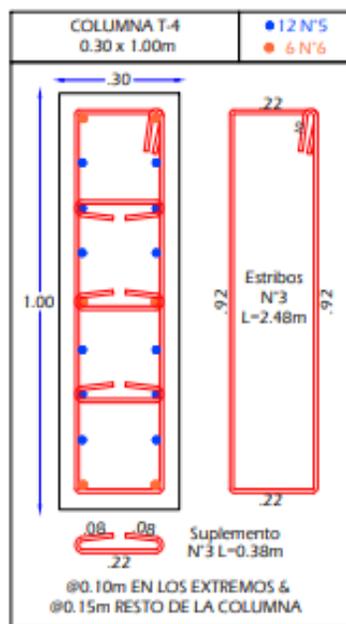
Despiece de columnas T4 nivel 4 Edificio Wiedii.
